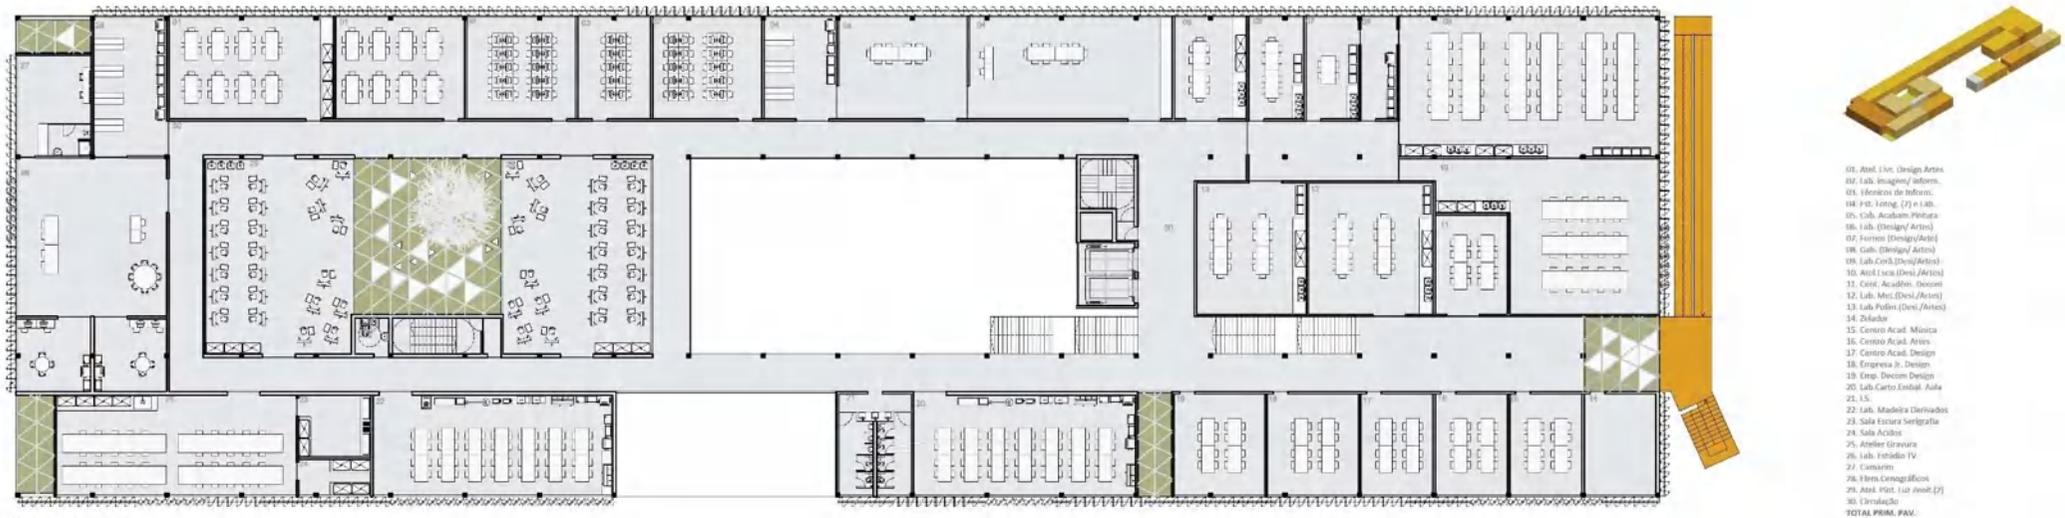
Planta baixa do pavimento térreo da edificação histórica no Campus Cabral da UFPR (sem escala)
